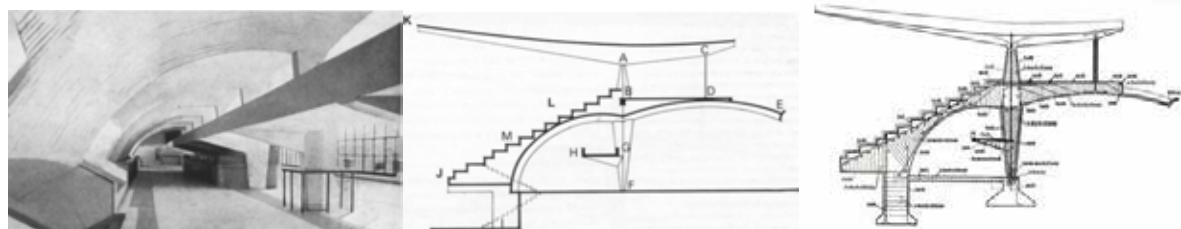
Visión interior del hall principal y la ménsula HG correspondiente a los esquema estructural por partes o de la armadura y laminas de las seccion transversal de la zona de la tribuna y cubierta.
